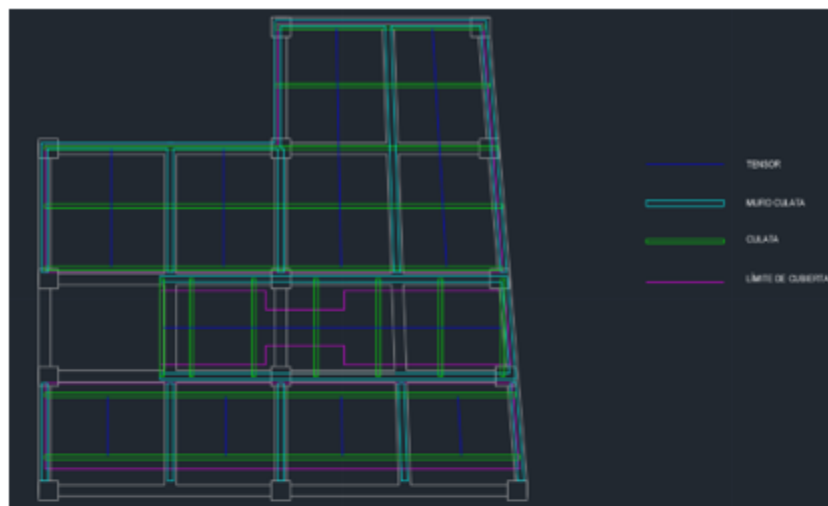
Planta de distribución de elementos de soporte de la cubierta
